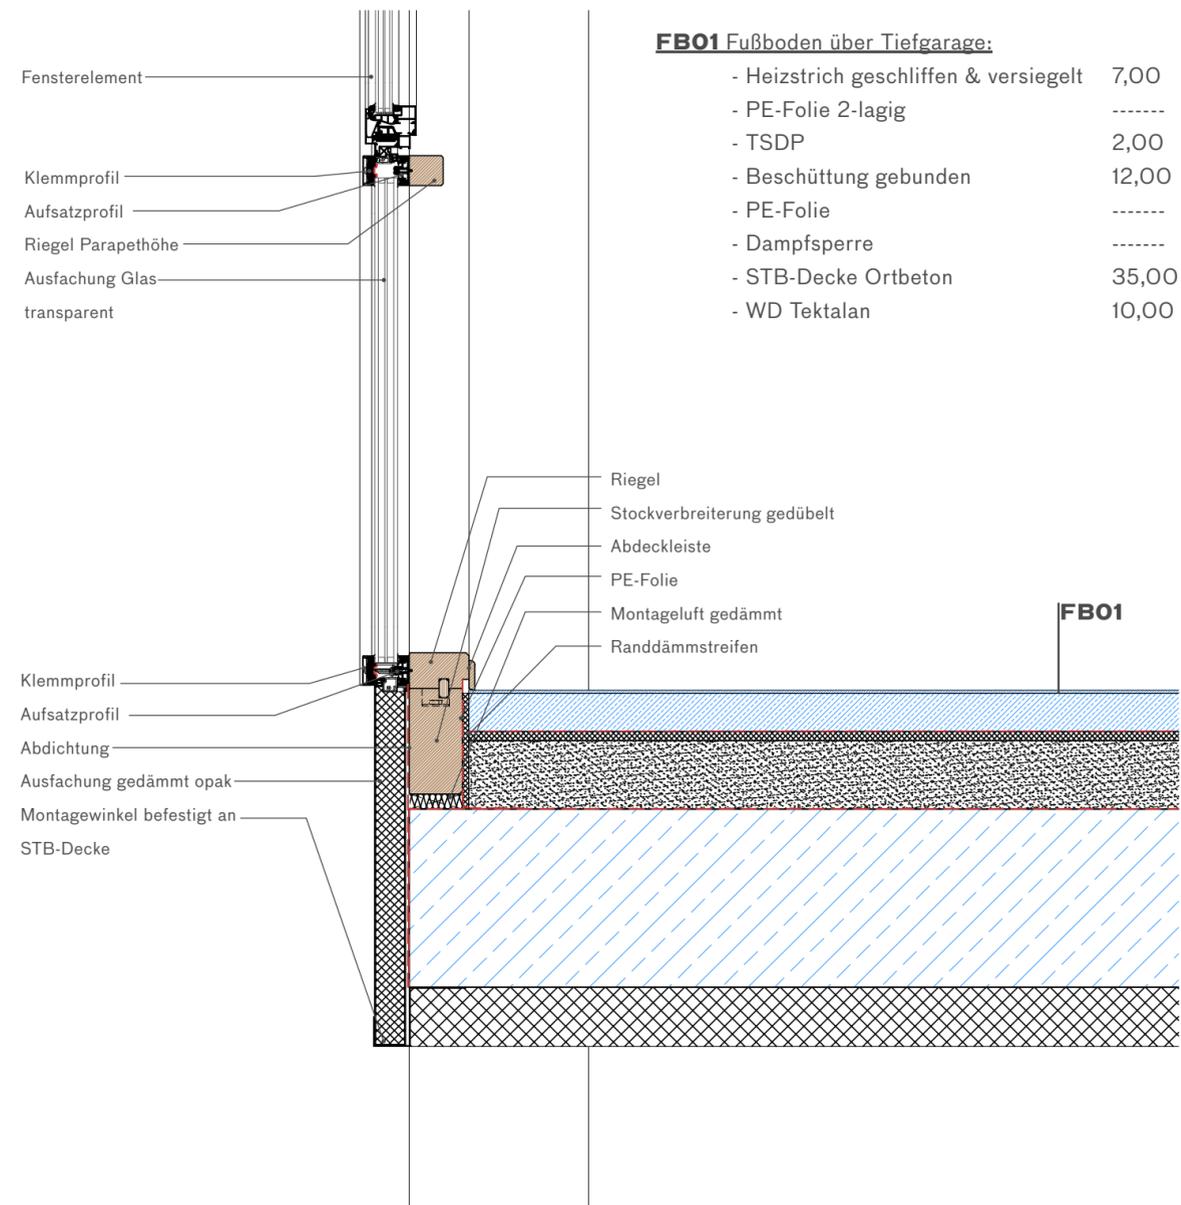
Detail - unterer Anschluss Tiefgarage Pfosten Riegel Fassade
